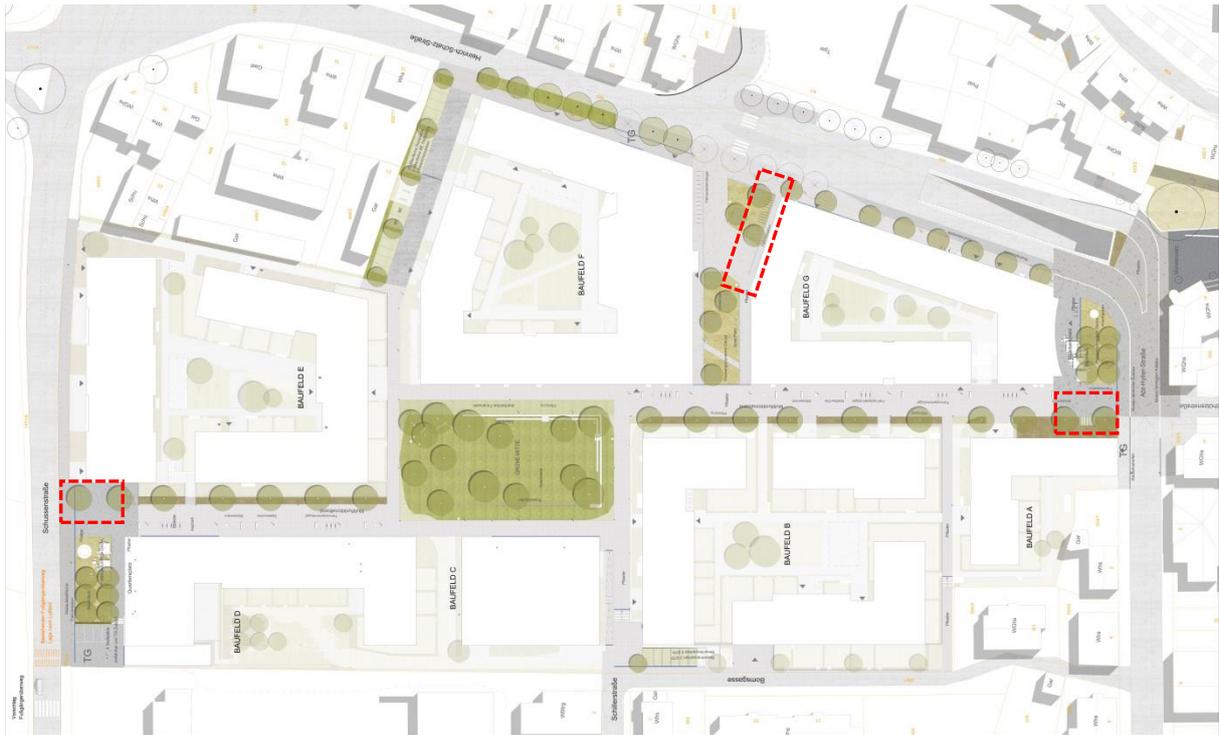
Lageplan mit Darstellung der Bereiche der Bike-Sharing-Stationen
